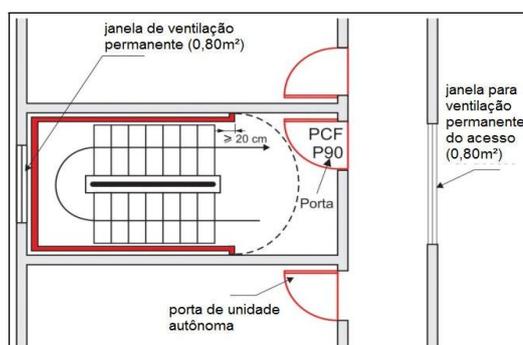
Ventilação da escada enclausurada protegida e seu acesso
